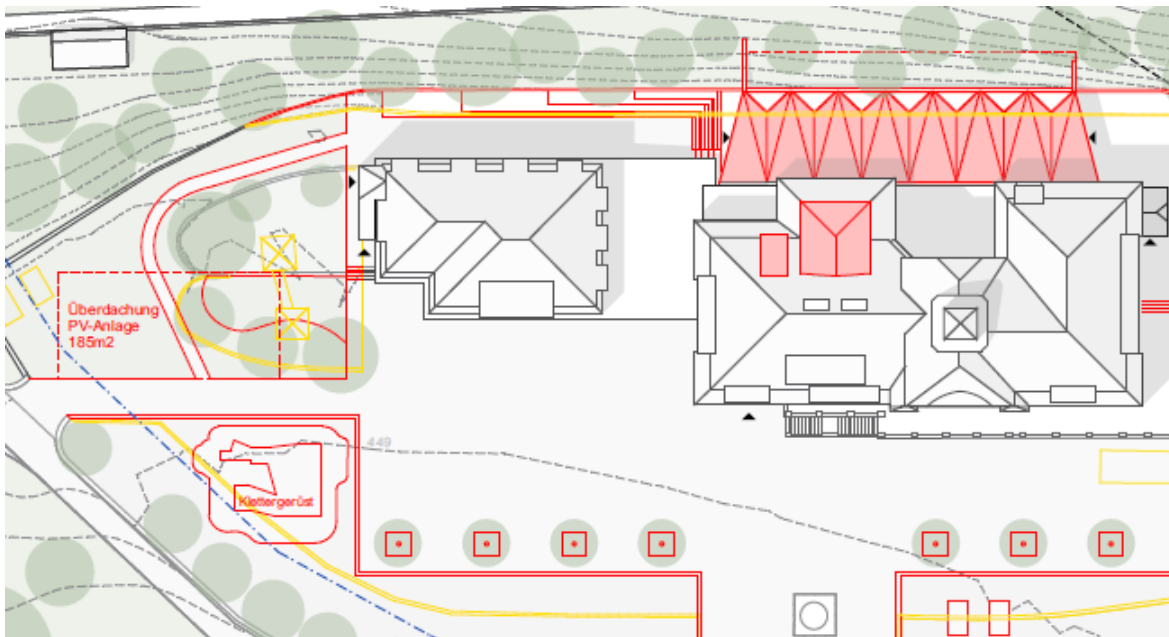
Möglicher Standort der Pausenplatzüberdachung mit PV-Anlage (ohne Massstab)
